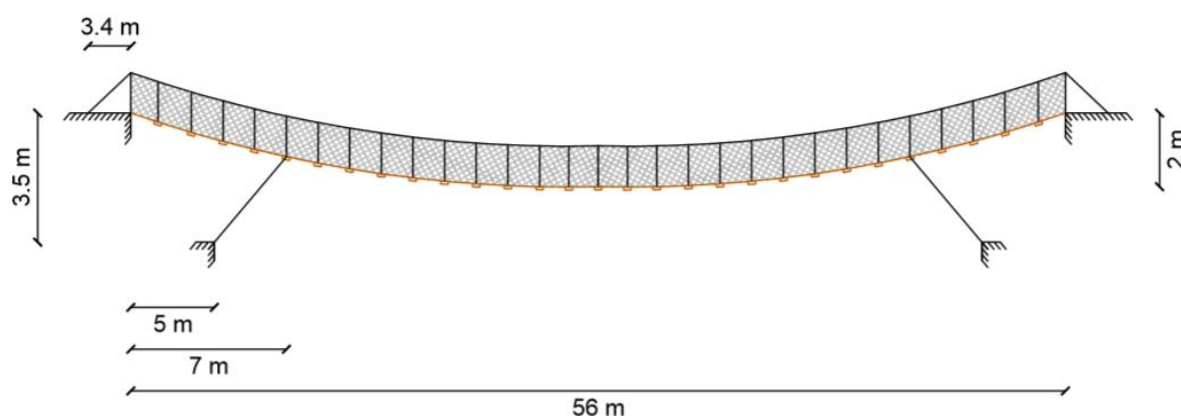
Configuração da ponte com apenas 4 espigas situadas a 7 m dos apoios.
